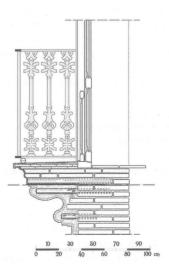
Alzado y sección constructiva de un balcón perteneciente al siglo XIX, Calle Maldonado
